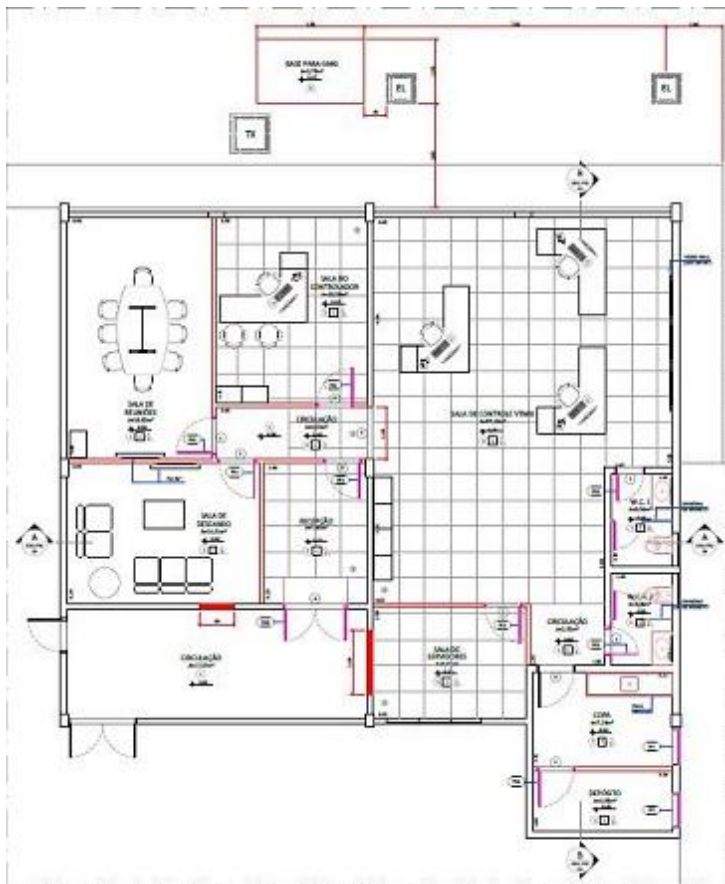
Planta baixa do VTMISS de Vitória. Fonte: CODESA
